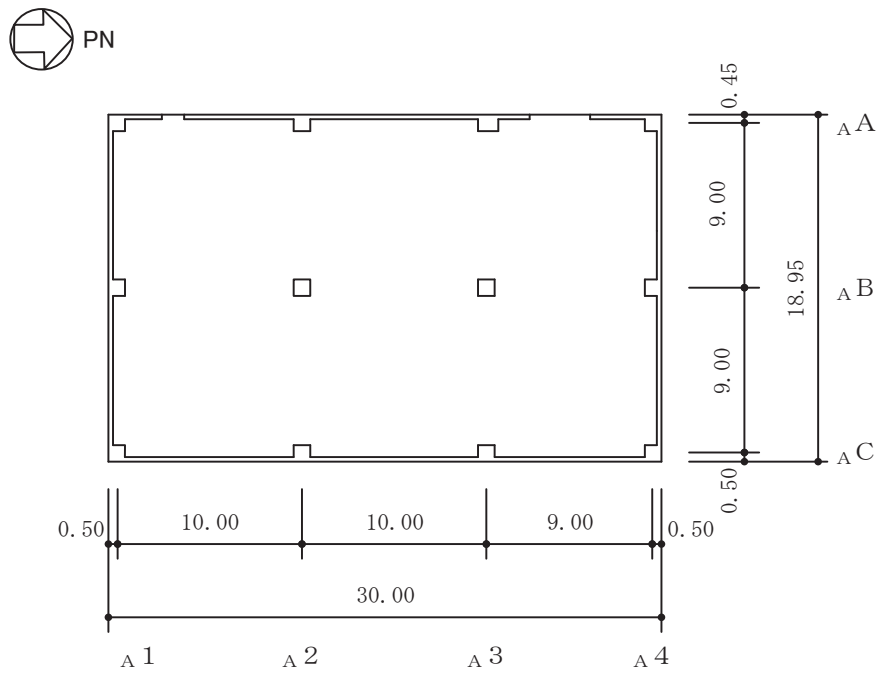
(1) 補助ボイラー建屋の概略平面図 (O.P.*11.0m)
